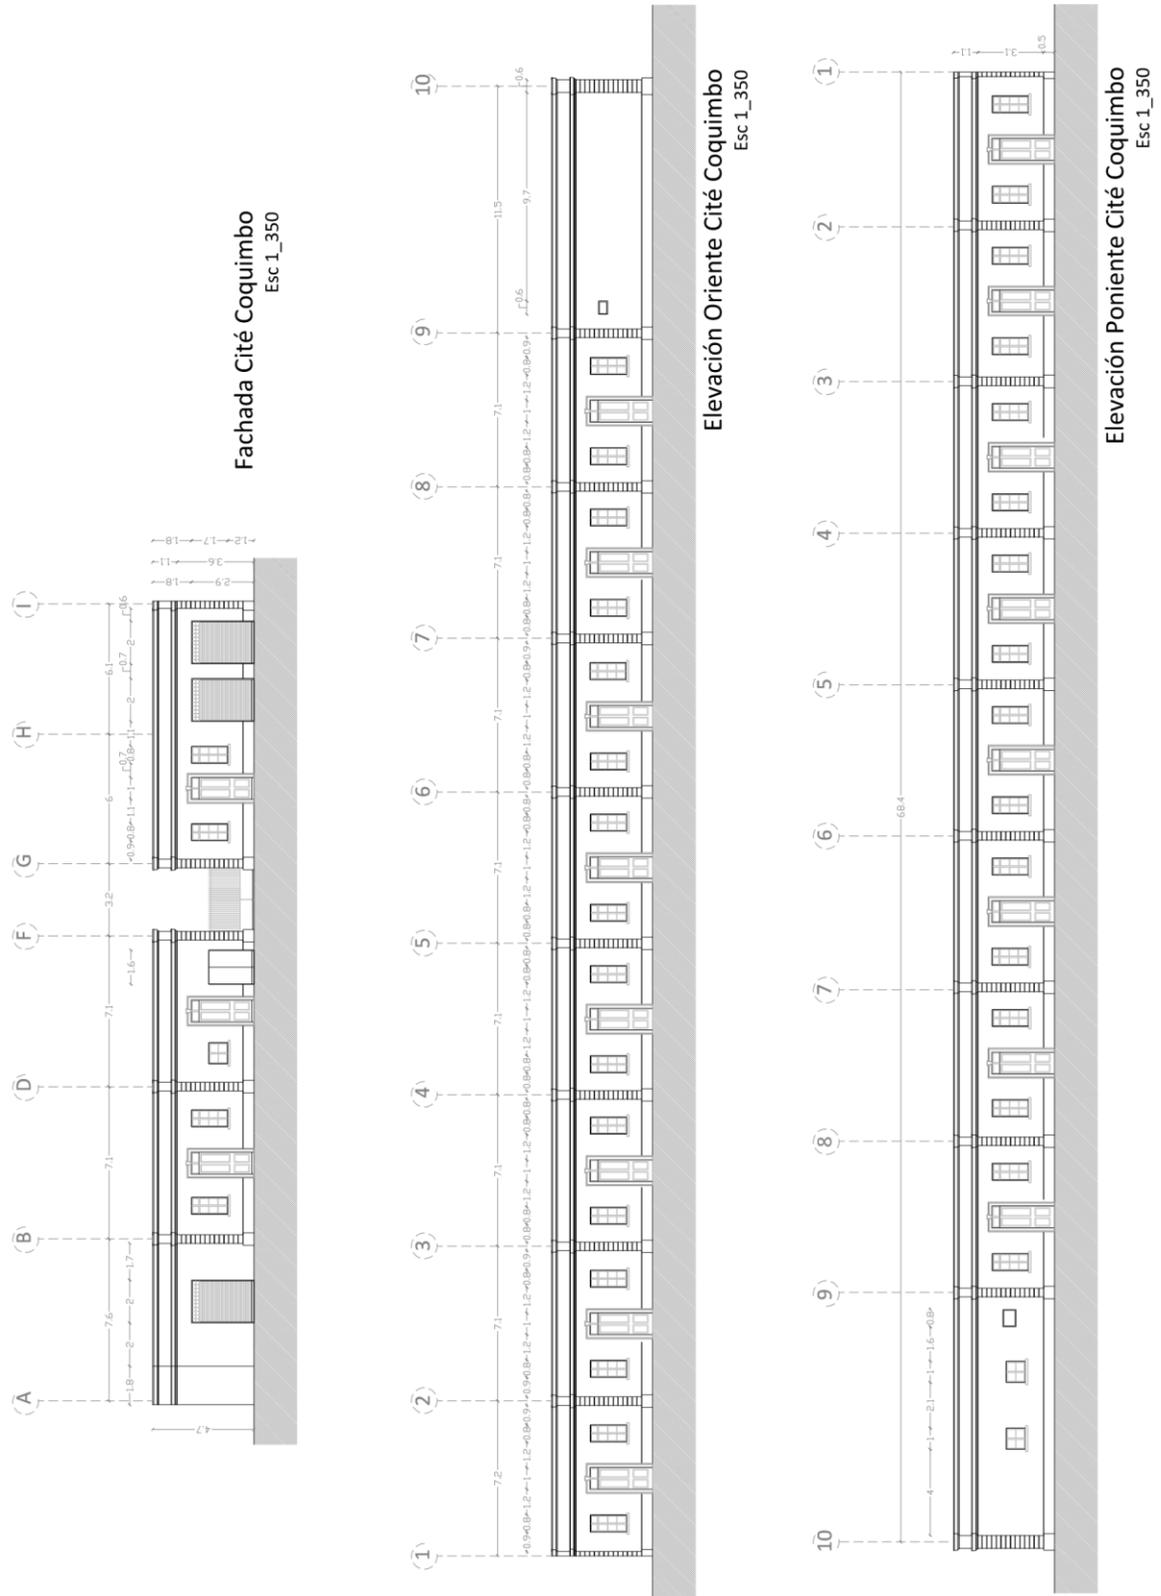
Planta Conjunto 105) Elevaciones Conjunto
